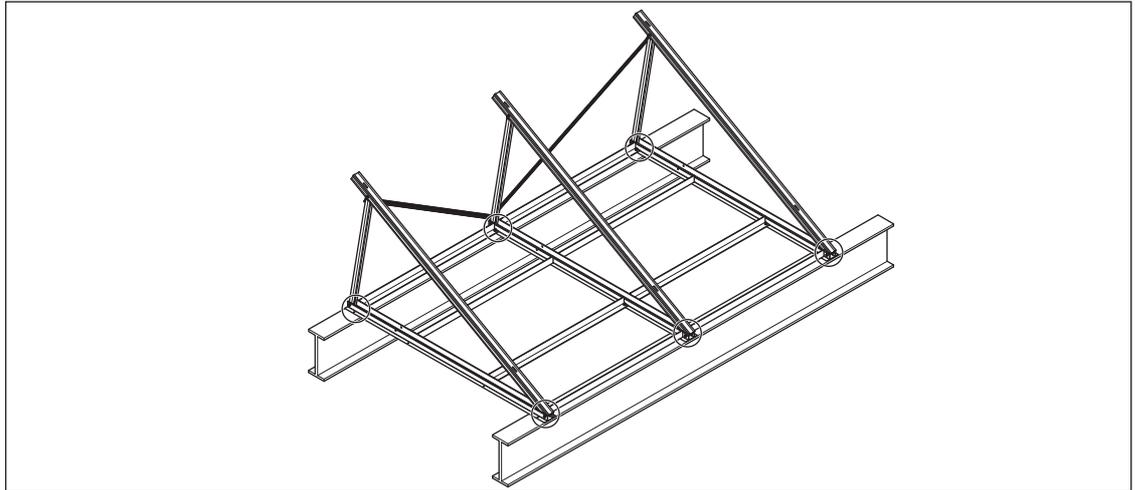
Aseguramiento de la construcción independiente en tejado plano mediante subestructura
